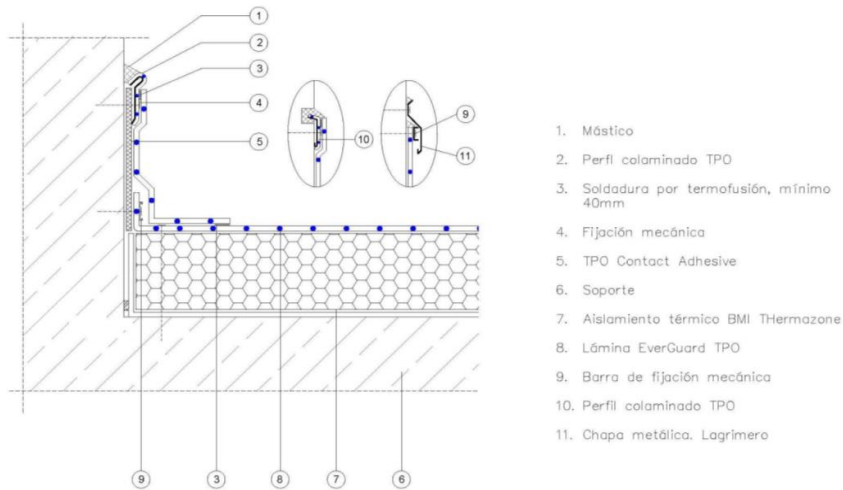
Remate peto perimetral con perfil colaminado.
